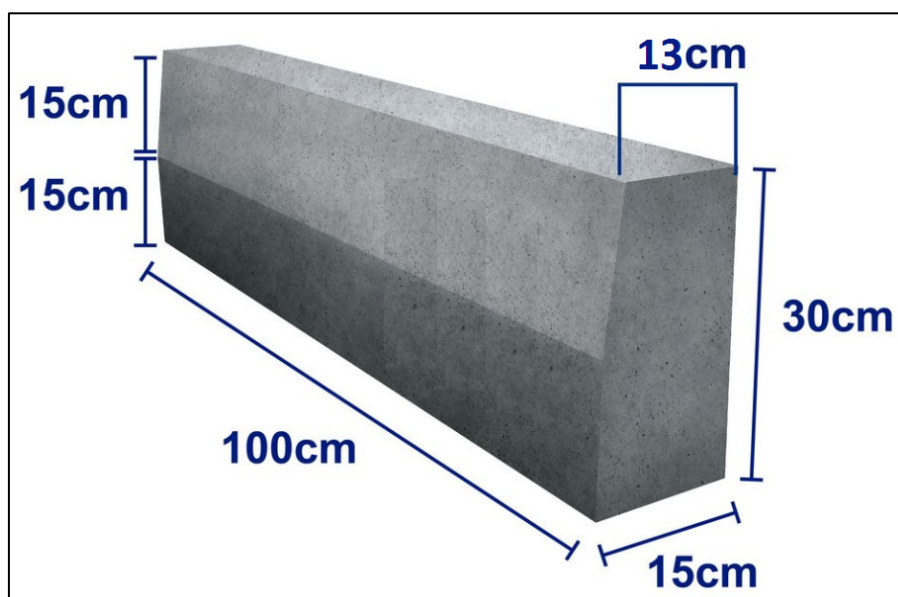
Modelo de Meio-fio de Concreto Pré-Fabricado
